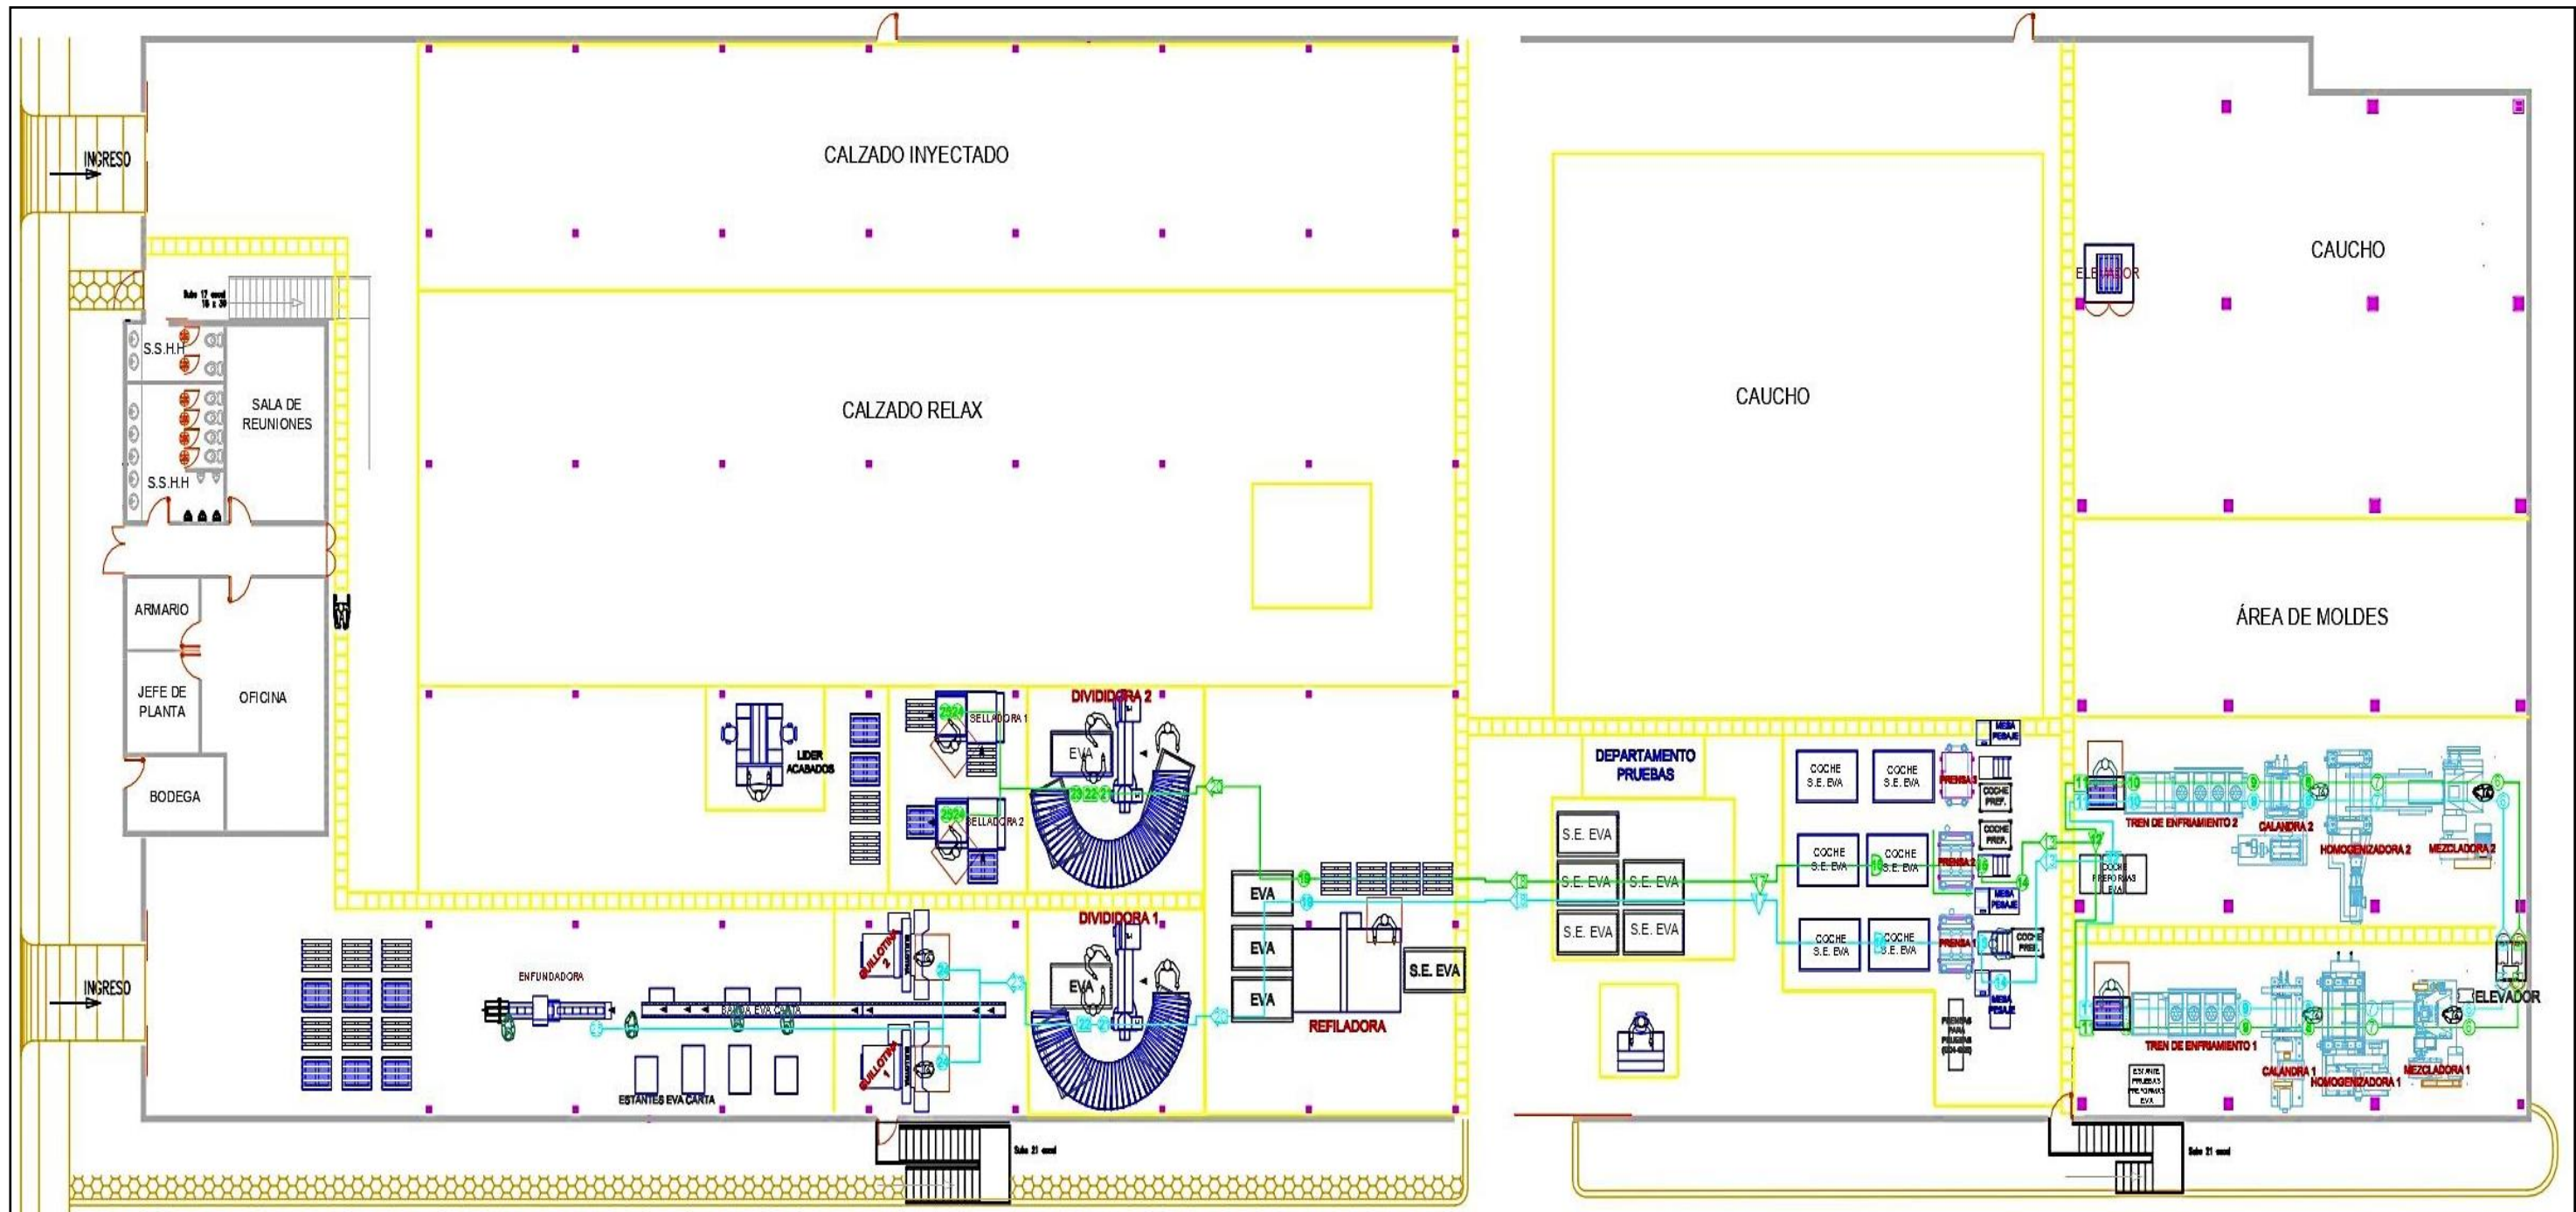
Construcción del Layout en AutoCAD (Planta Baja)
